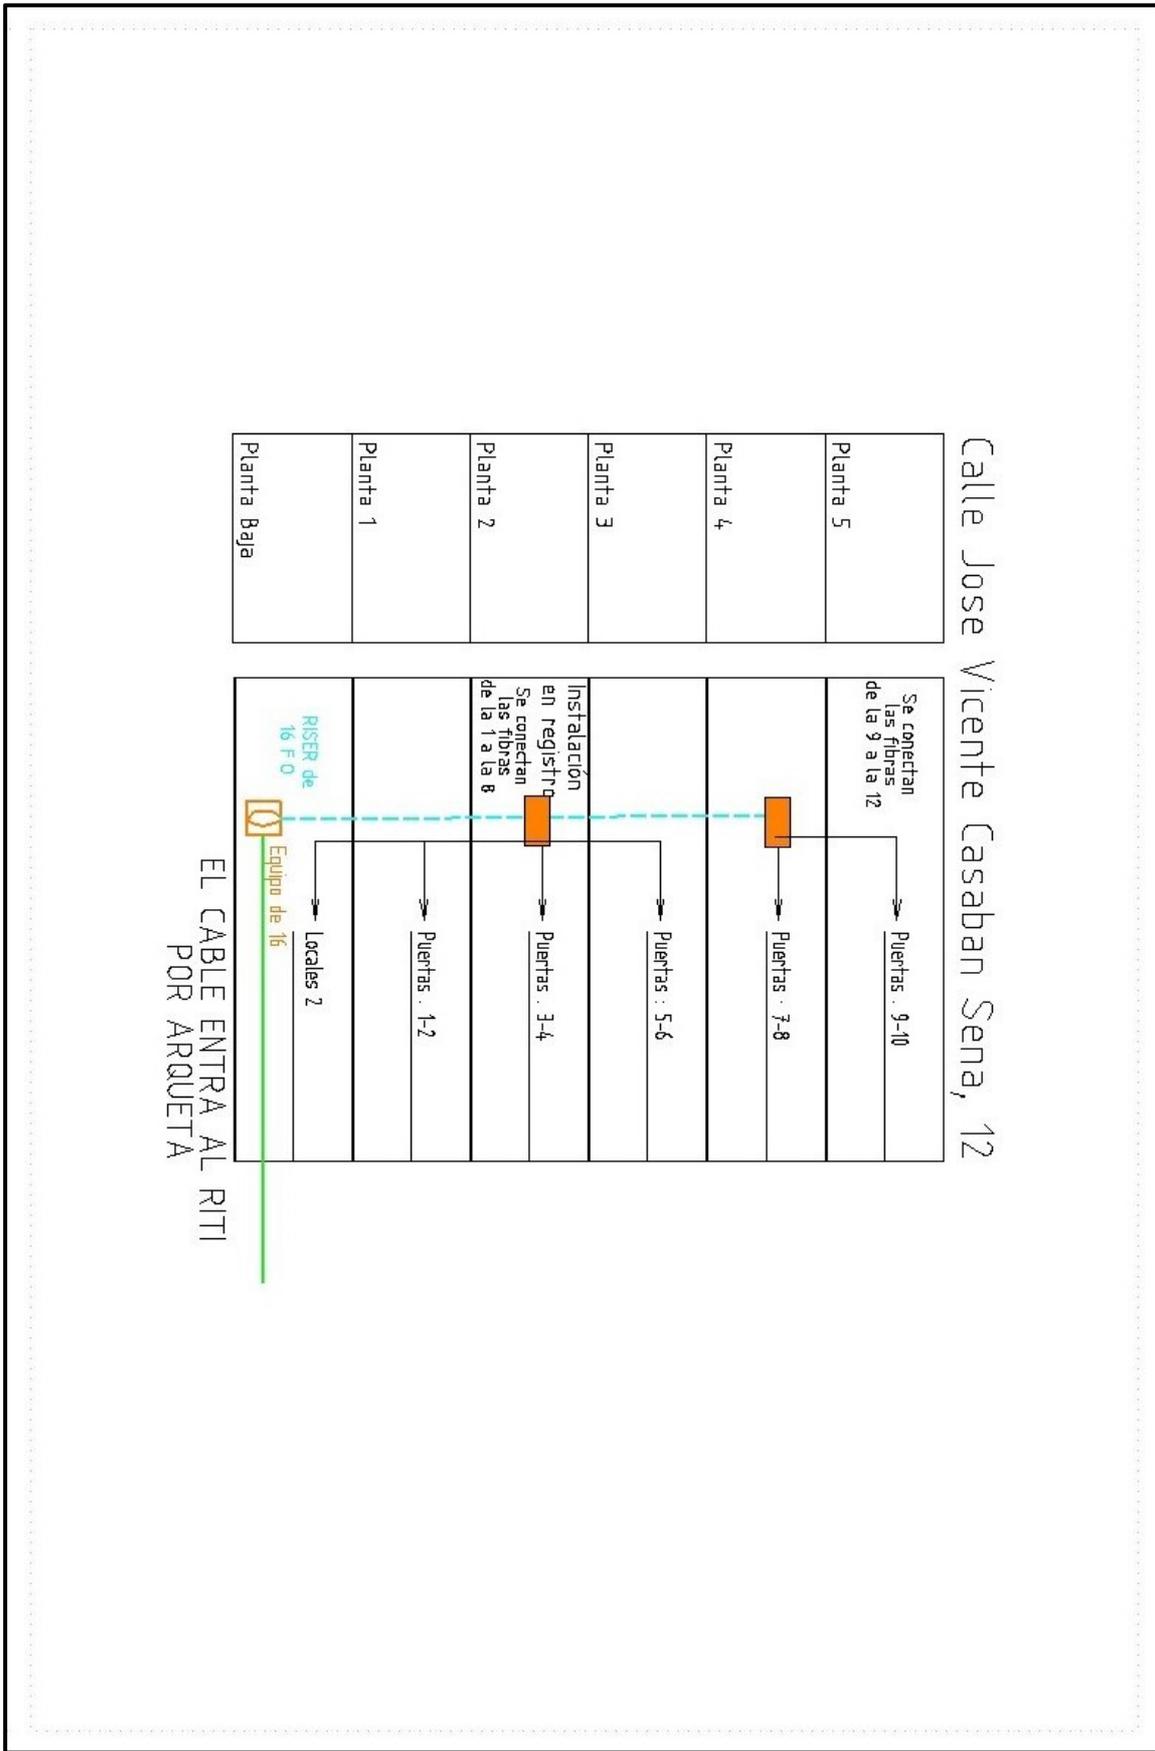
Plano Jose Vicente Casaban Sena, 12
